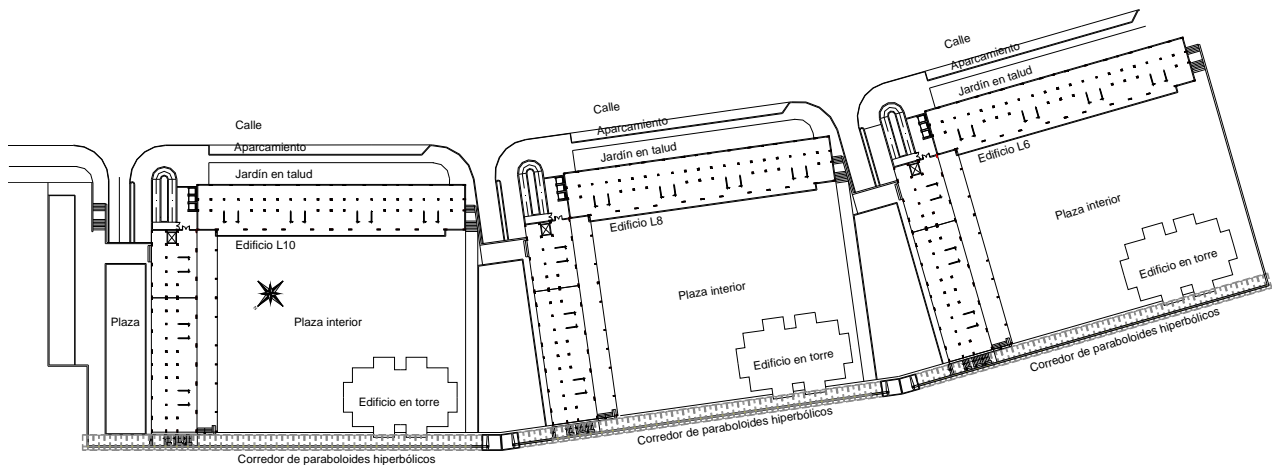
Planta de conjunto de la Unidad 2 de Caranza.
